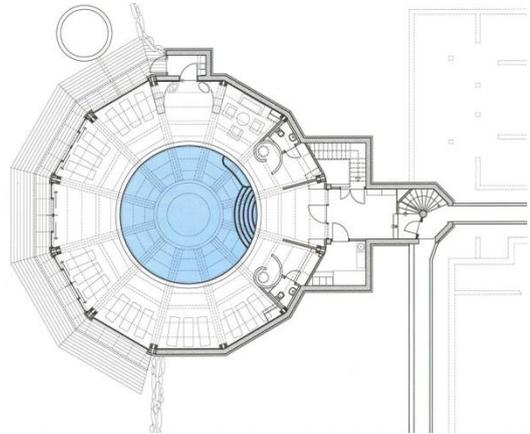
Grundriss Schwimmbad - „Biohotel Daberer“
